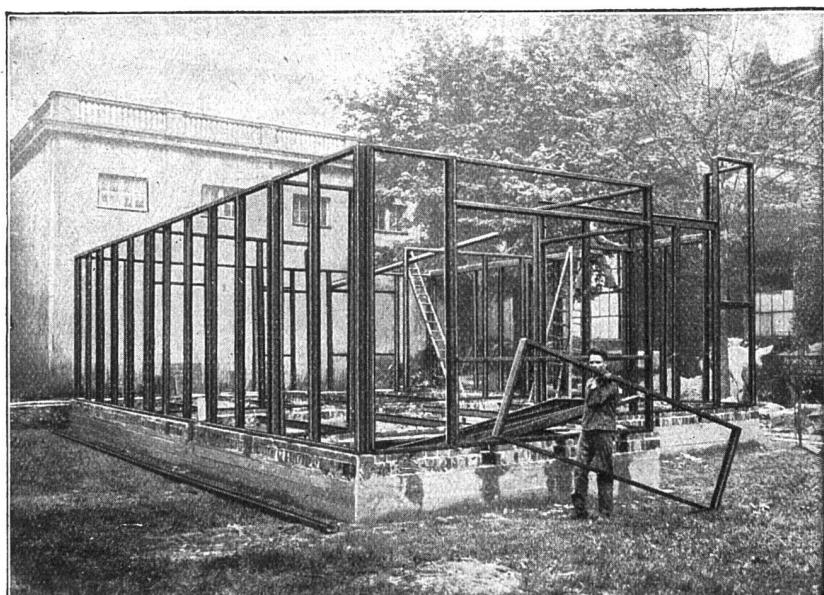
Montage der Erdgeschosskonstruktion eines Stahlrahmenhauses
